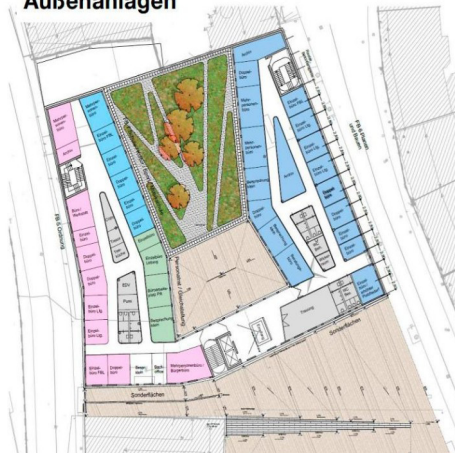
Grundriss OG 1, 2, 3
